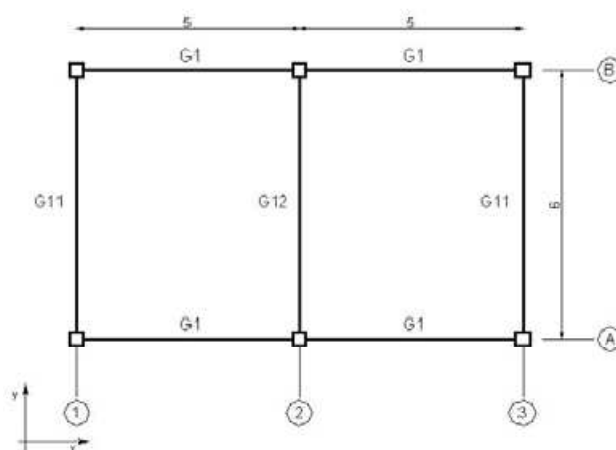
Vista em planta da estrutura em estudo (m)
